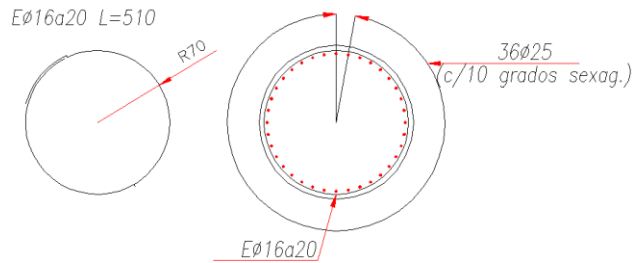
Detalle estribo y sección pilares cepa A en mm.
